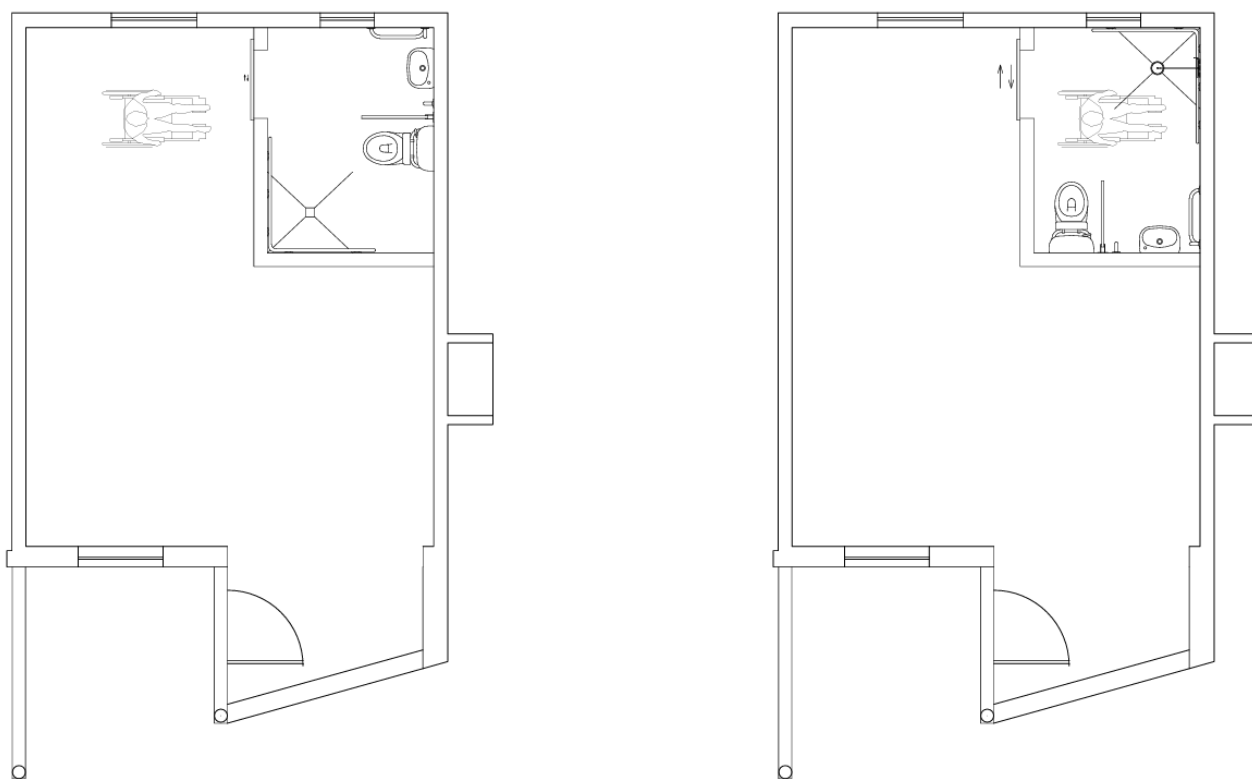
e 36 – Plantas de estudo - *Bungalow 1* (Fonte: autora)
